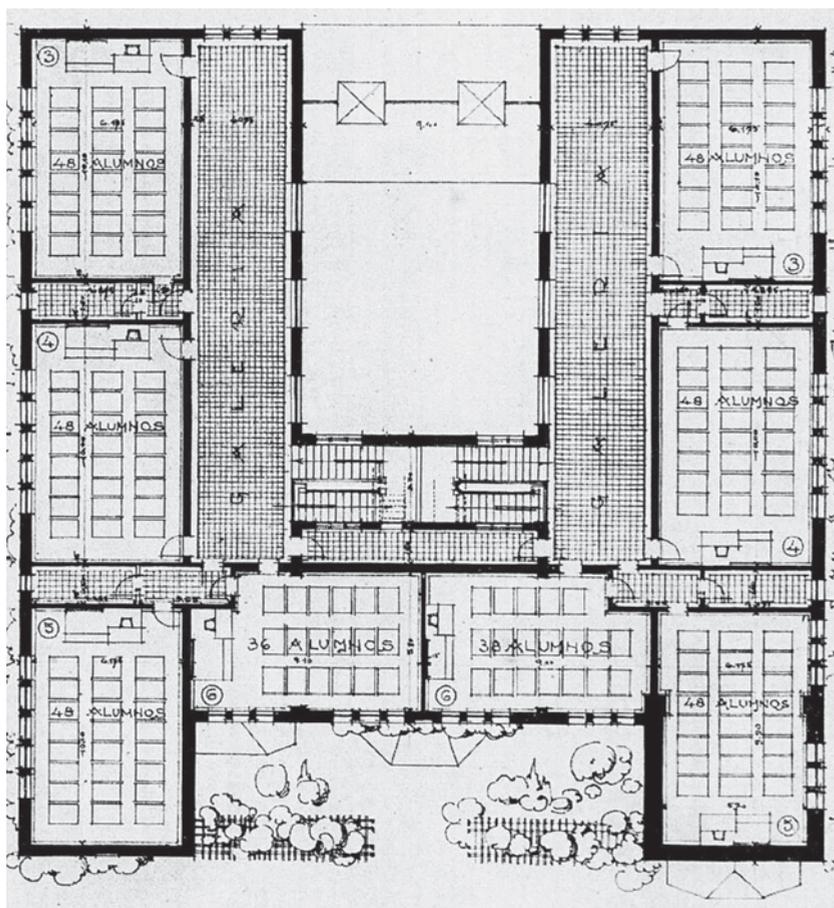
Grupo Escolar de Nova Friburgo: Planta baixa do segundo pavimento
